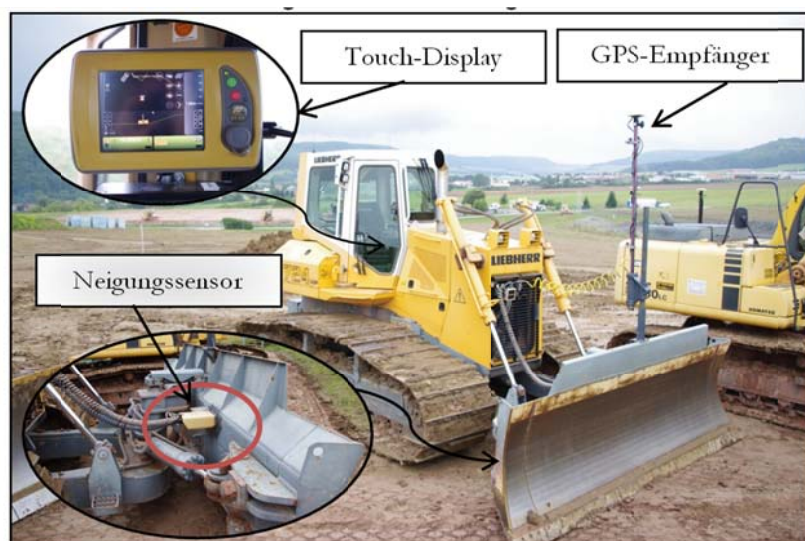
Dozer mit Maschinensteuerungssystem Topcon 3D GPS (GPS+ Neigungssensor)
